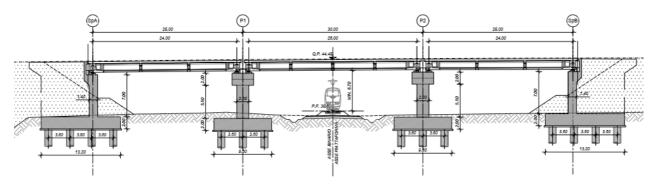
Cavalcaferrovia NW03 – Sezione longitudinale
